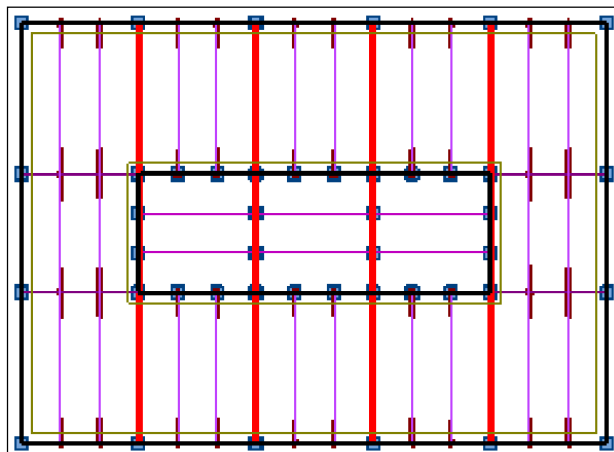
Vigas com ligações por rótula substituídas por ligações resistentes a momento
